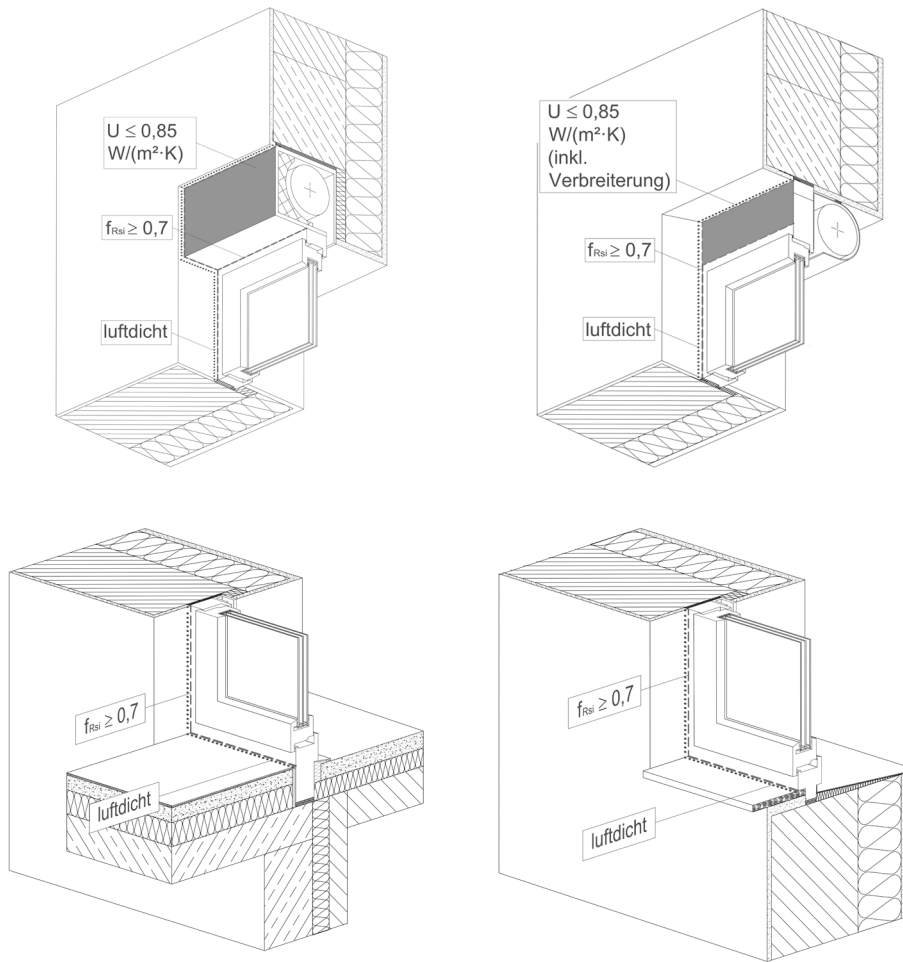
Darstellung der Anforderungen an den Mindestwärmeschutz an Fenster und Fenstertüren nach [12]
